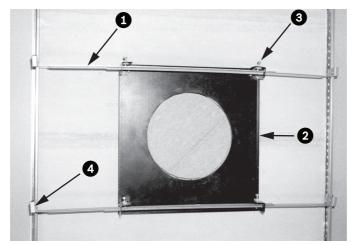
Support pour suspension au plafond (vue supérieure)
